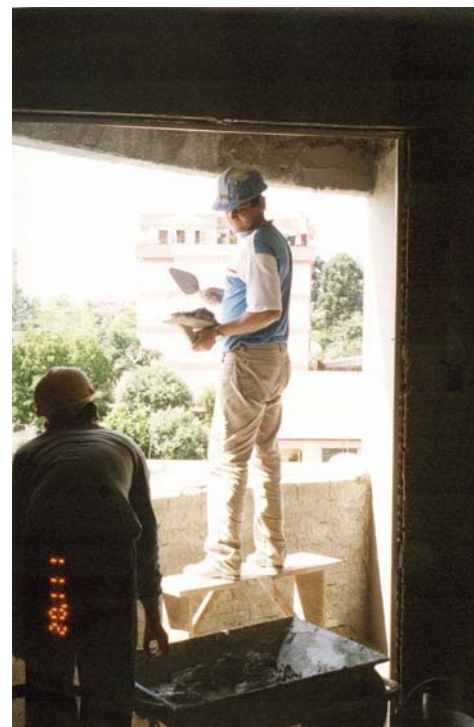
Vista parcial e andaime suspenso da obra 2
